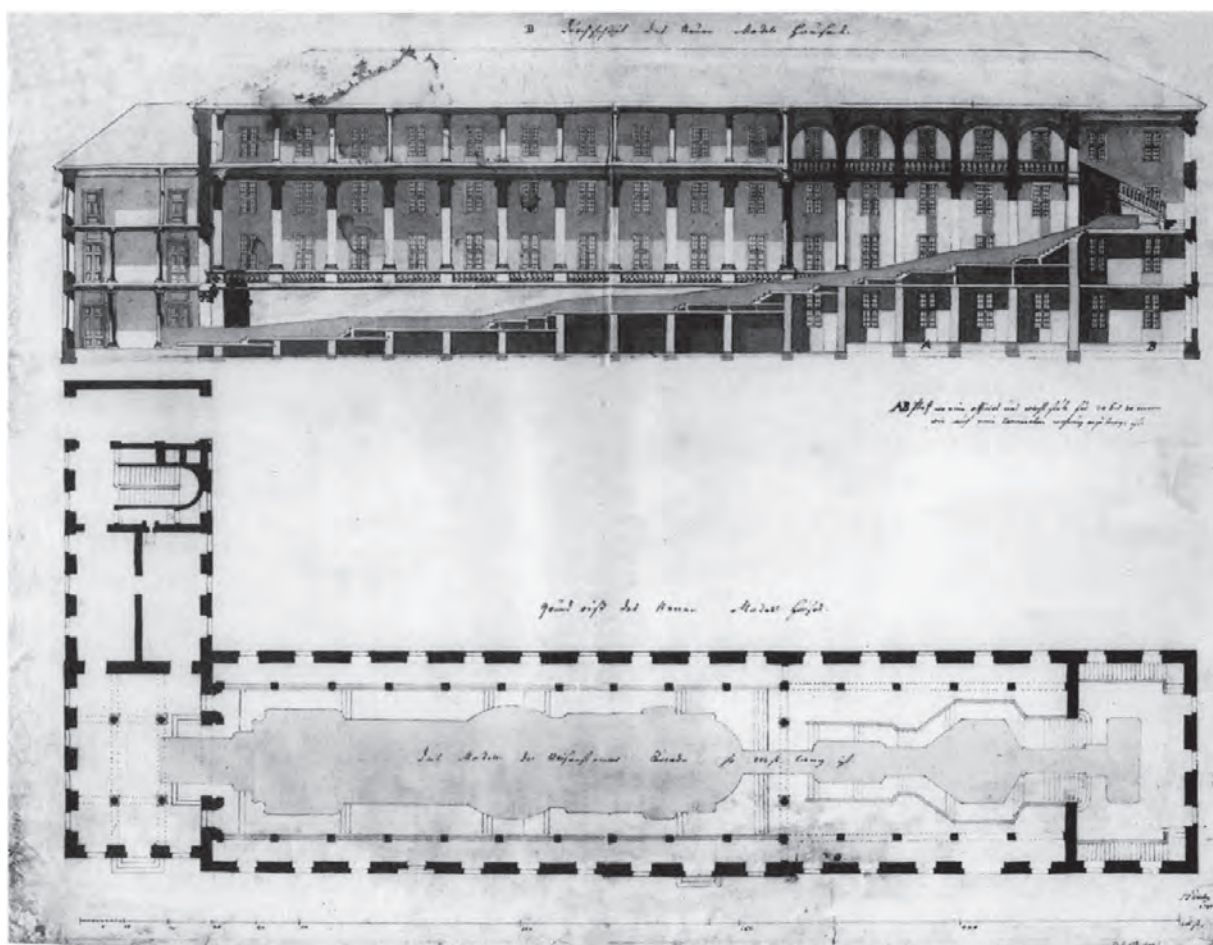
Simon Louis du Ry, Entwurf für ein Modelhaus, Längsschnitt und Grundriss, 1780
